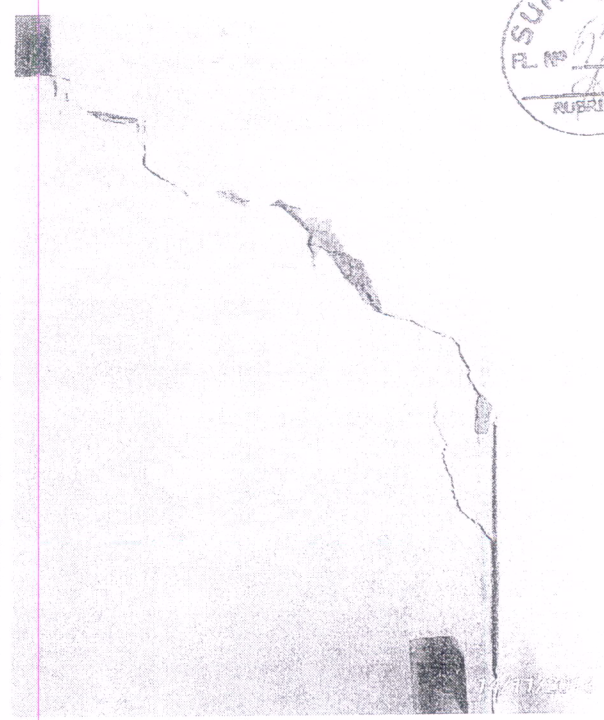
Fissuras ao longo do piso de vários dormitórios, coincidindo com a continuidade de fissuras das alvenarias;
